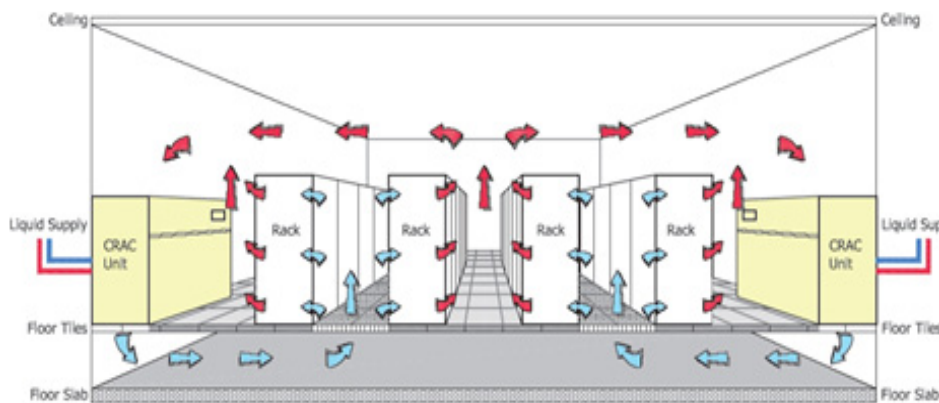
Installationsboden-Luftverteilungsplan (ASHRAE)
